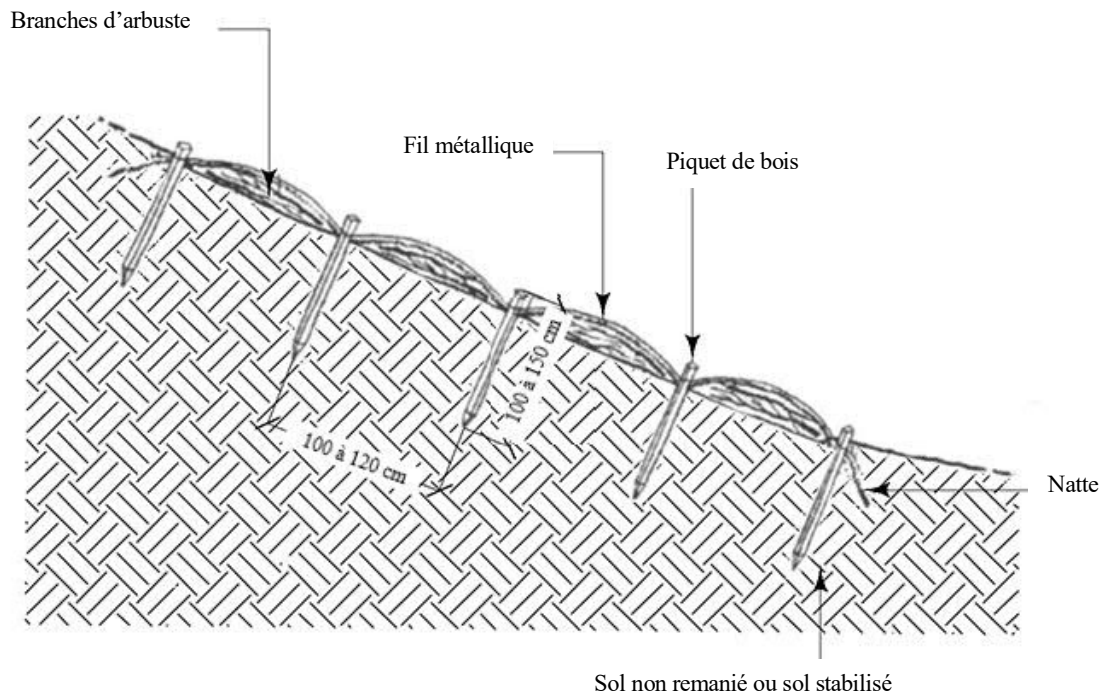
EXEMPLE D'INSTALLATION DE MATELAS DE BRANCHES
